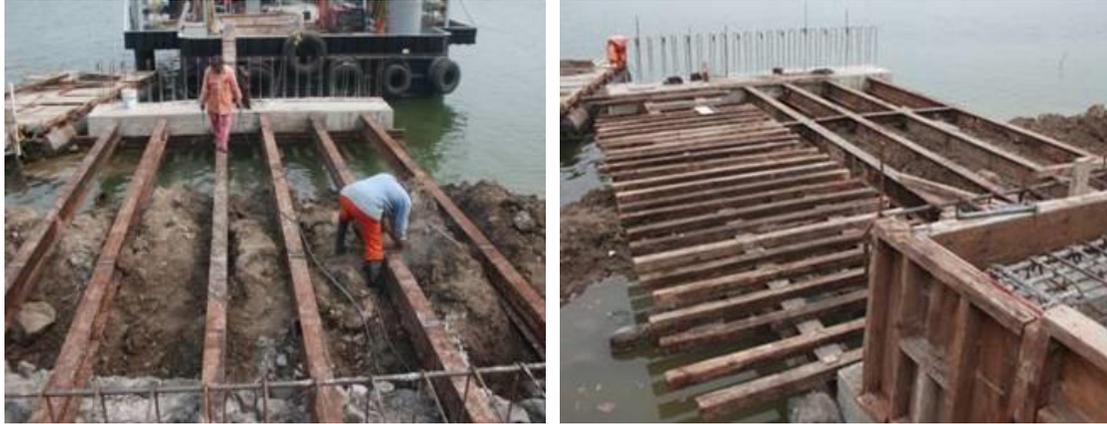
Viguetas IPR tipo I de 12"x6.5" (obra falsa) para la construcción de la pasarela de acceso al muelle en río.
